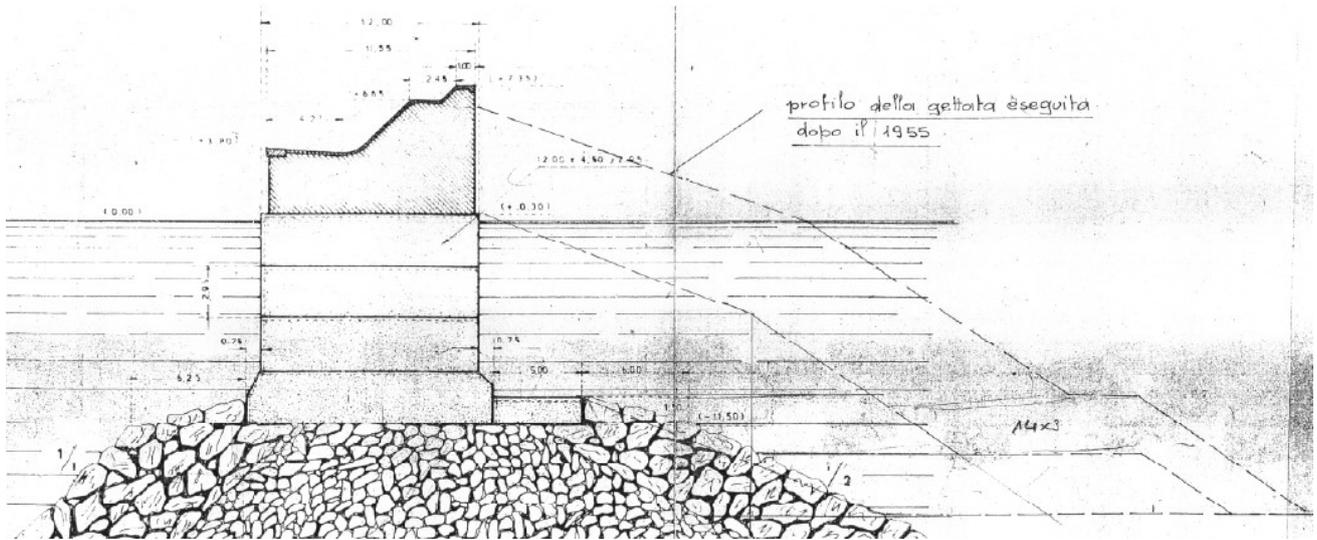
Sezione trasversale C'-D (Diga Bacino Sampierdarena) – Estratto da relazione MI046R-PF-D-Z-R-003-06 del PFTE
